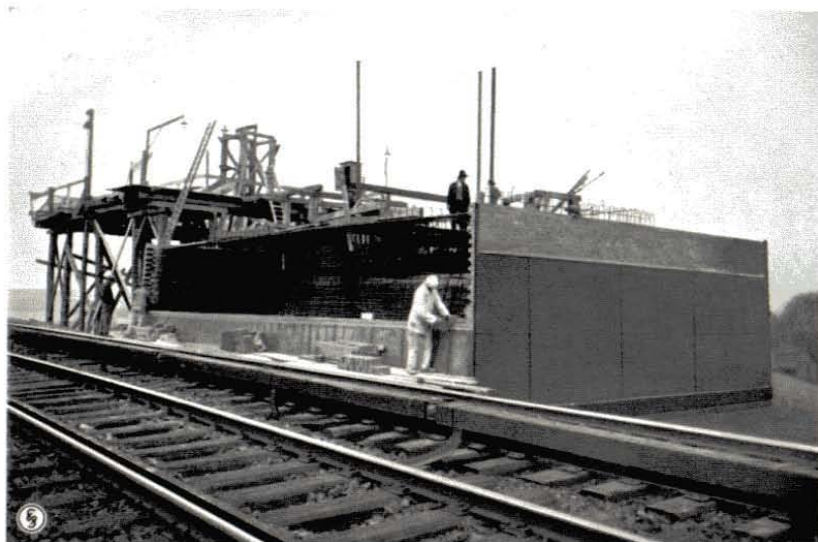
Ringbahnkreuzung: Westwiderlager in der Schalung und Bewehrung begriffen mit Blechbekleidung
